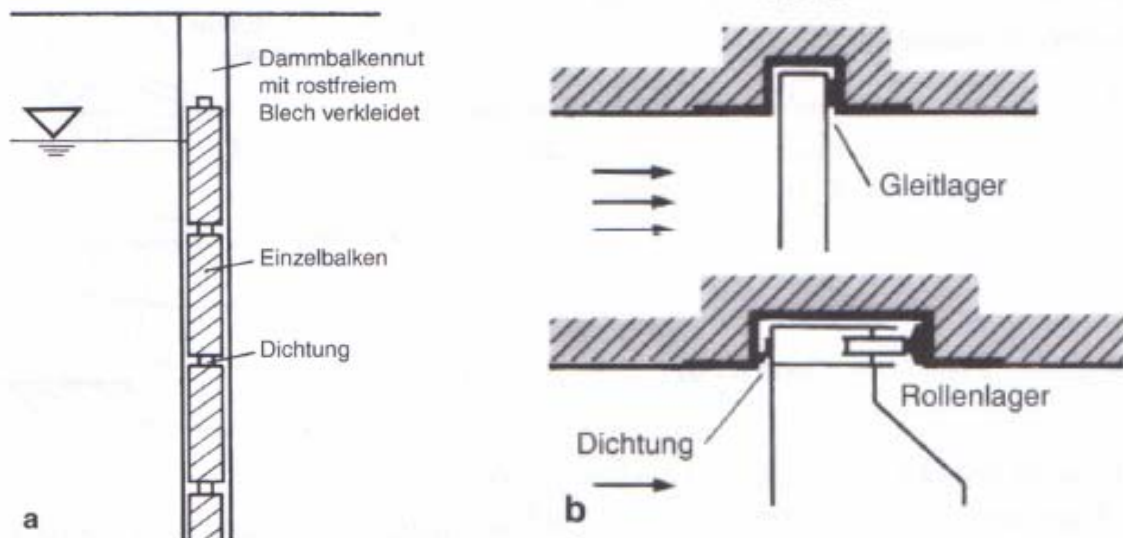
Grundsätzliche Anordnung von Dammbalken mit Gleit- oder Rollenlager. a Schnitt, b Grundriss, [Patt H., Gonsowski P. (2011), S.145]
